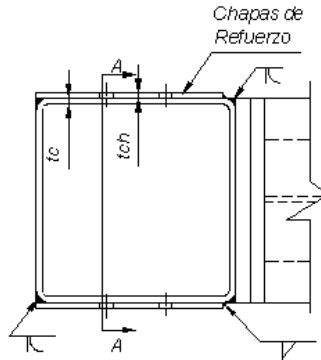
Soldaduras filete y tapón- Unión de chapas y "T" a la columna
